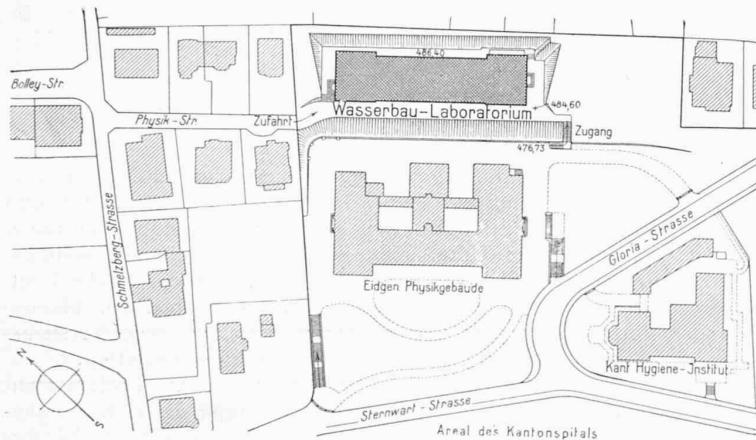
Lageplan des projektierten Wasserbau-Laboratoriums. — 1:2500.
